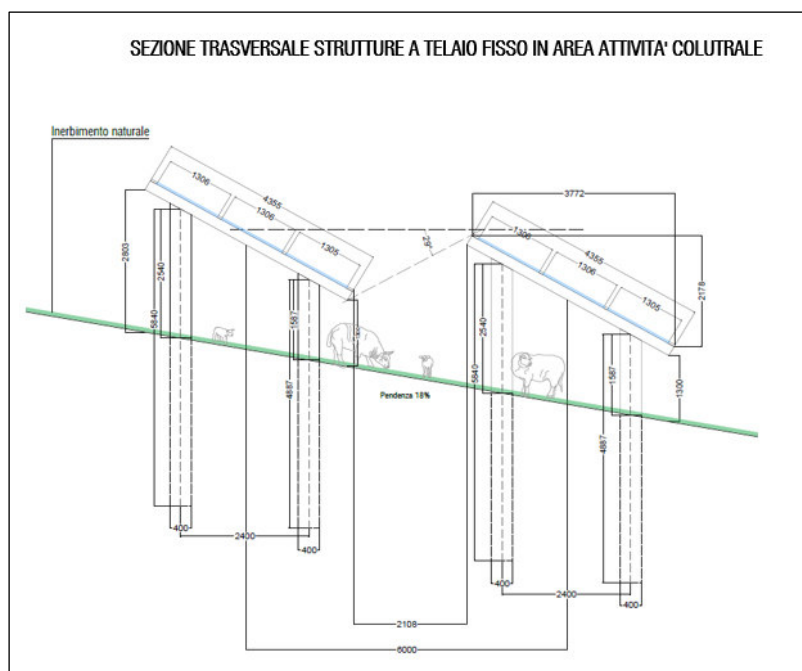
Sezioni trasversali struttura fissa cfr. Elaborato cod.PD.39 "Disegno Architettonico delle strutture"
